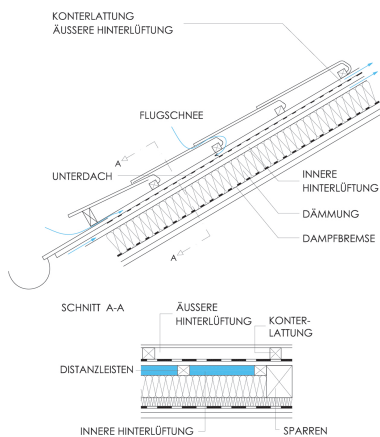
Hinterlüftung beim Kaltdach [Quelle: Riccabona/Mezera, Baukonstruktionslehre 2 (Ausgabe 2011) 162]
